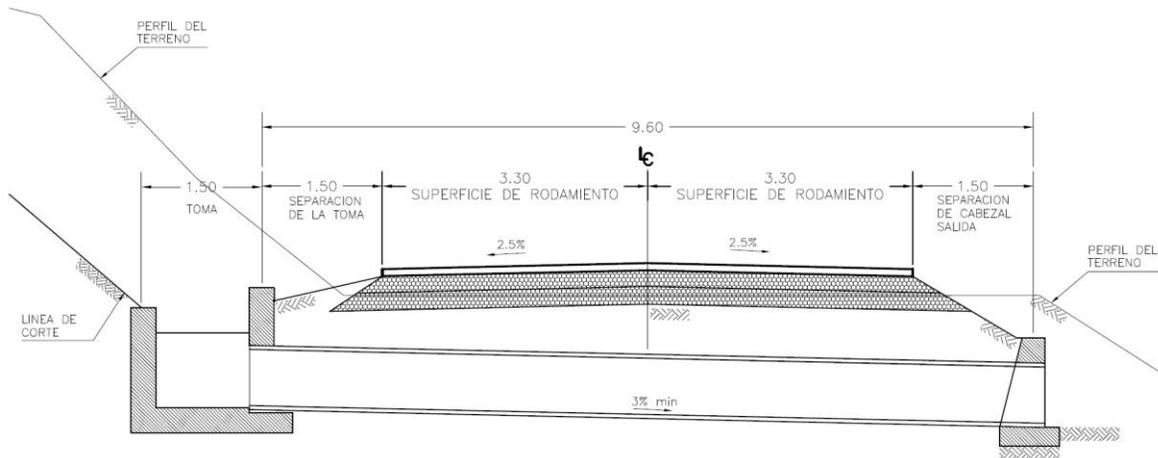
Ejemplo de Sección Transversal requerida en la ubicación de alcantarillas transversales.
